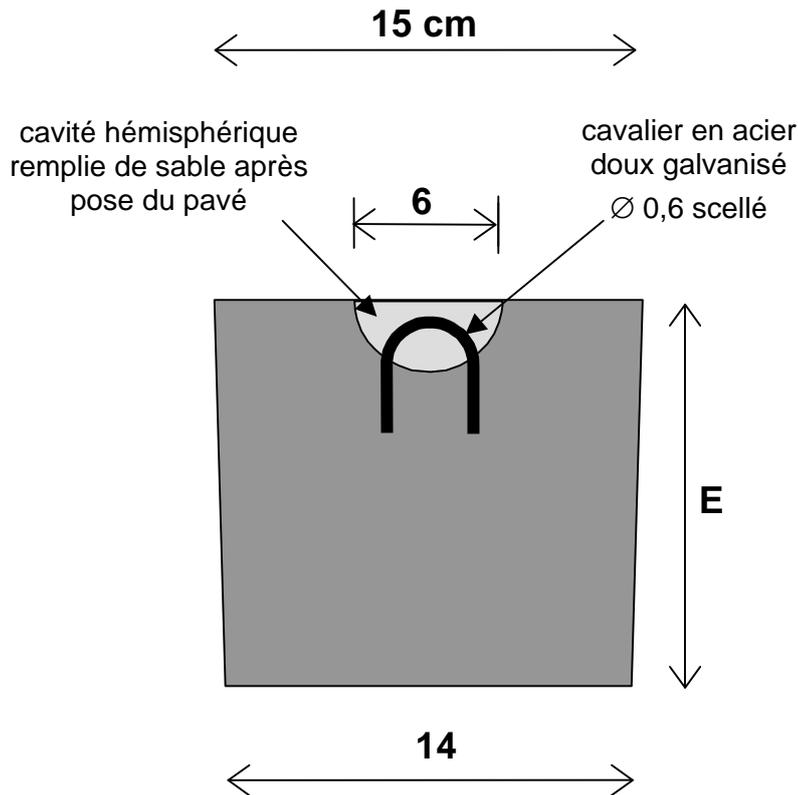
exemple de pavé spécial conçu pour faciliter le démontage de la chaussée.
